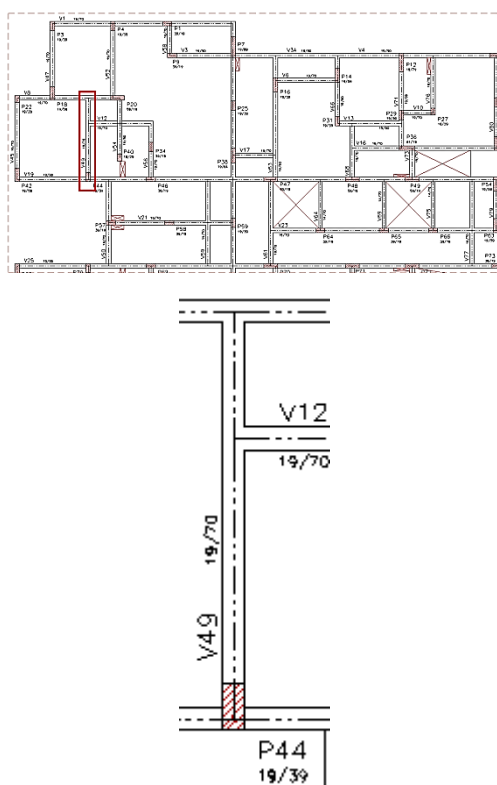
Edifício Vita Belle: localização da viga V49
